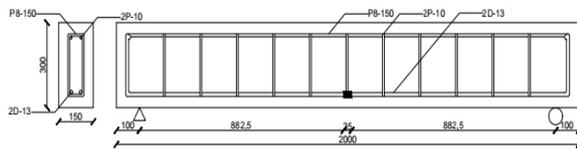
Desain Balok Beton Bertulang Sambungan Lewatan
